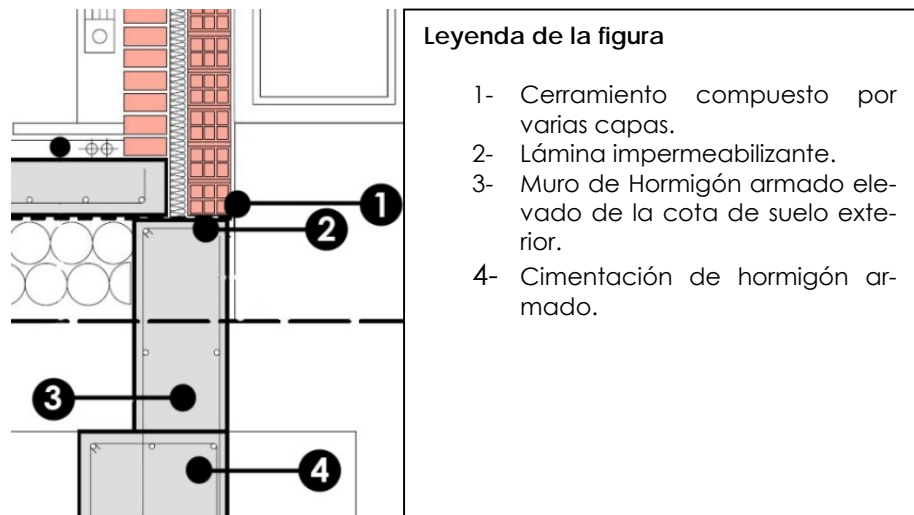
Base del muro. PAL-002. BT por el interior y apoyado en la solera. Fuente: Ignacio Vela Ciudad. Elaboración propia.
